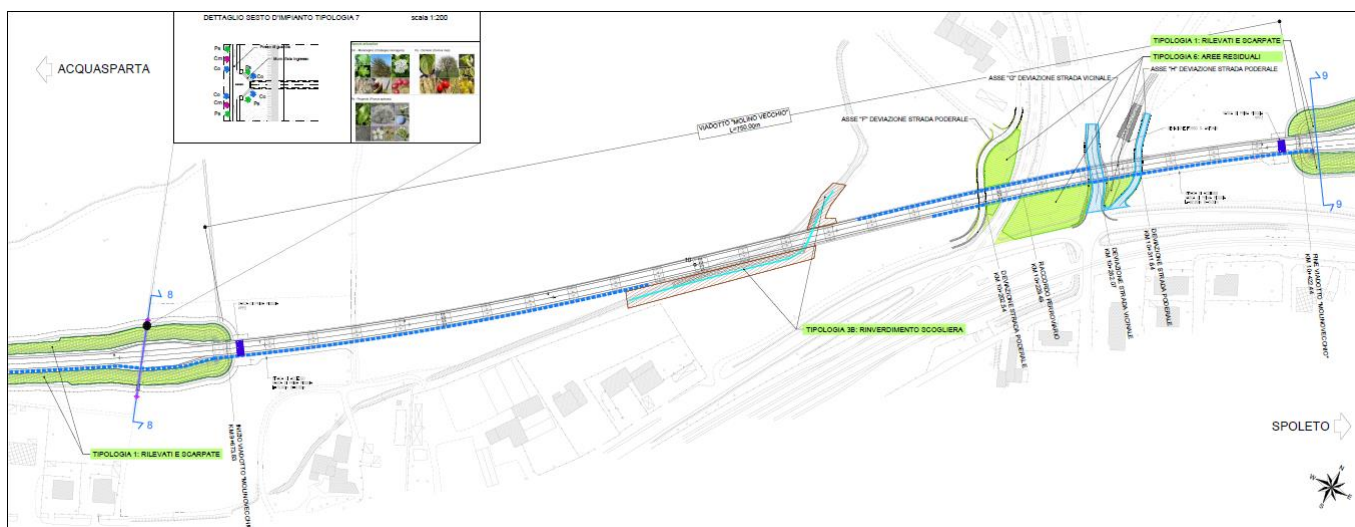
Planimetria con l'evidenza delle opere di mitigazione ambientale Viadotto Molino Vecchio.
